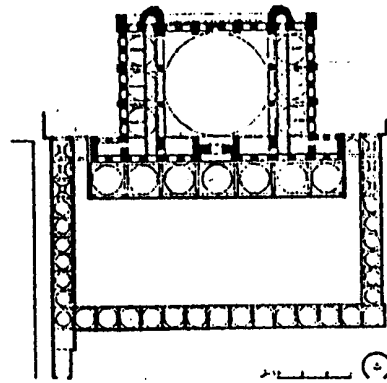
مسقط أفقي لجامع نبي بديار بكر
